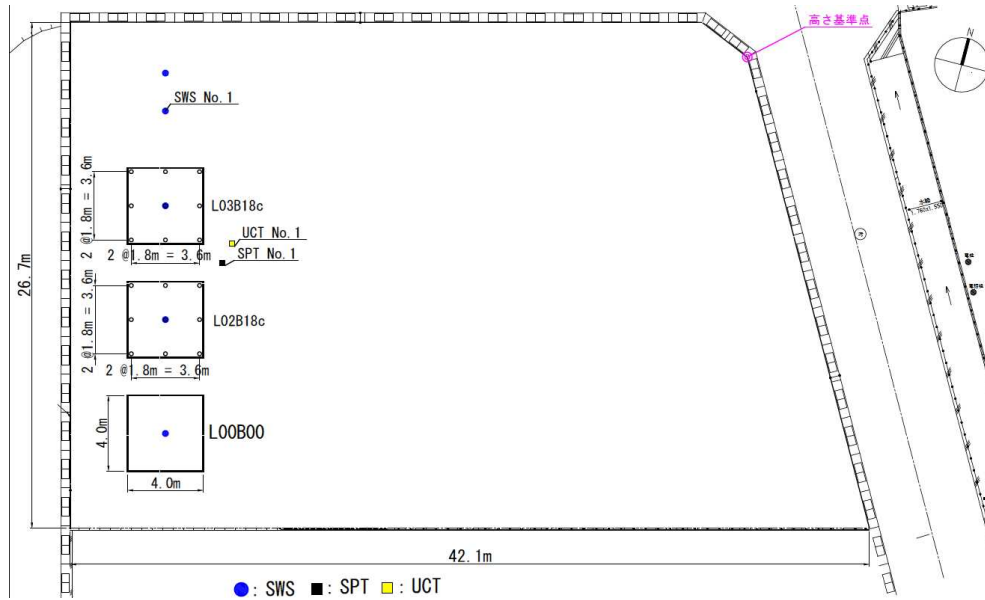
配置図と地盤調査位置 (SS 地点 : 佐賀県佐賀市)
